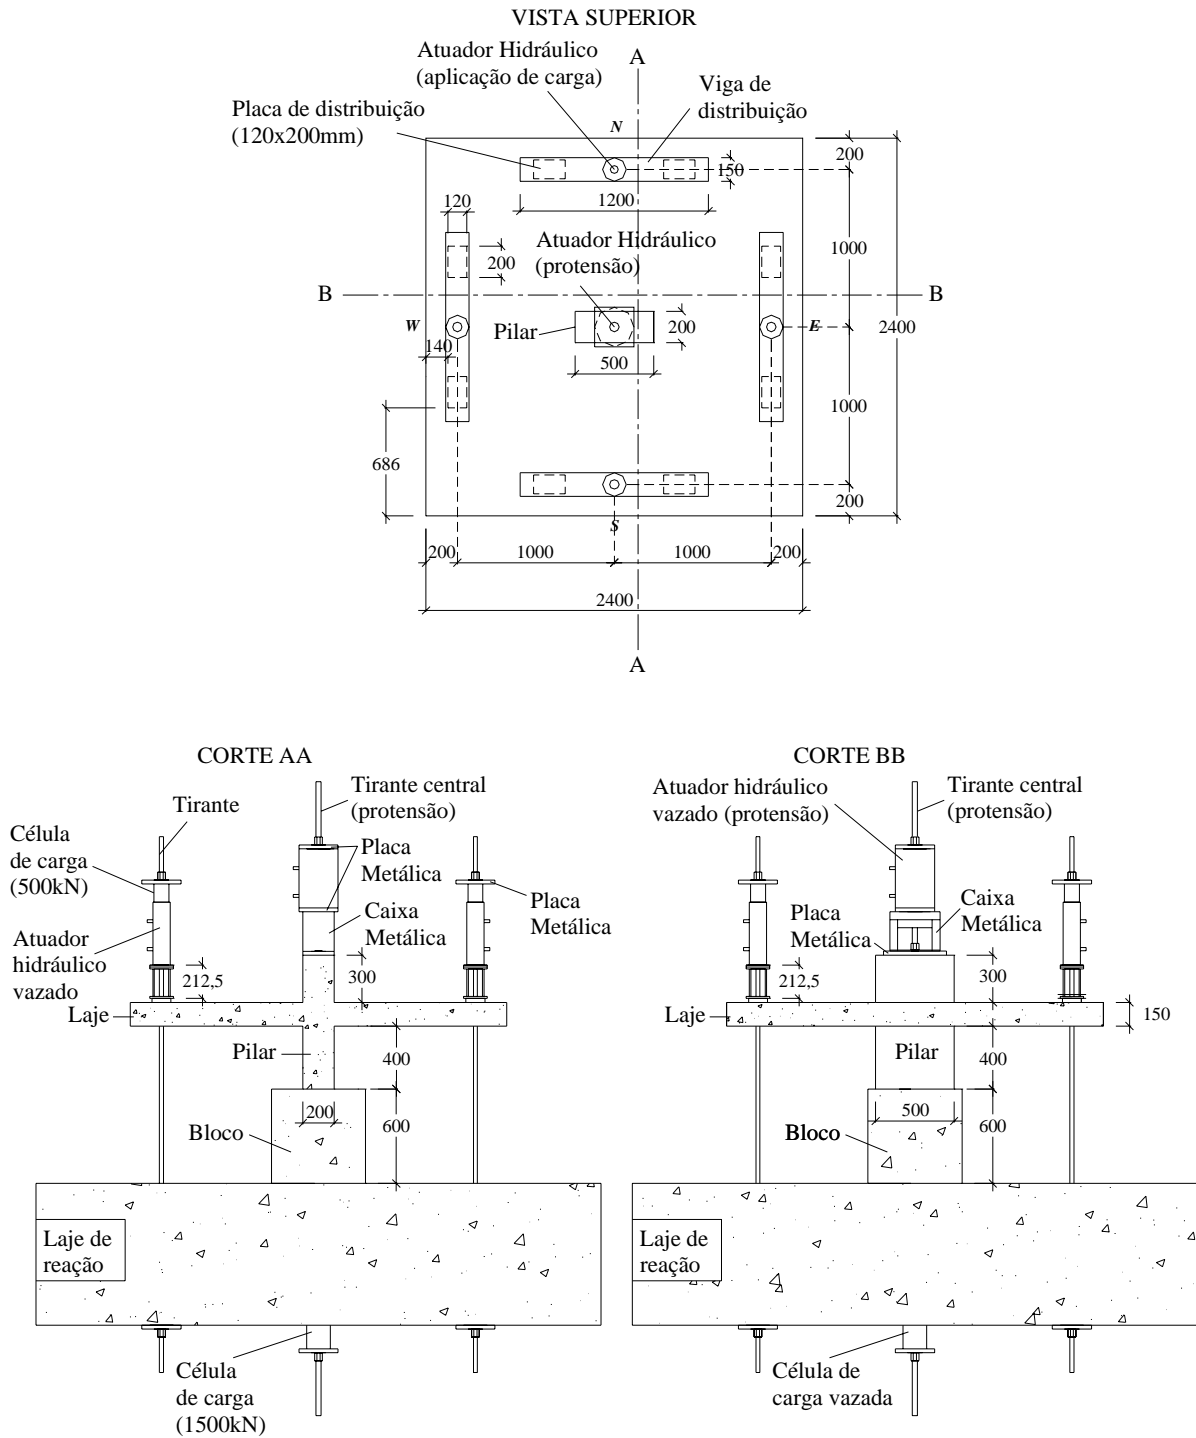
Sistema de ensaio, vista superior e cortes (mm)
